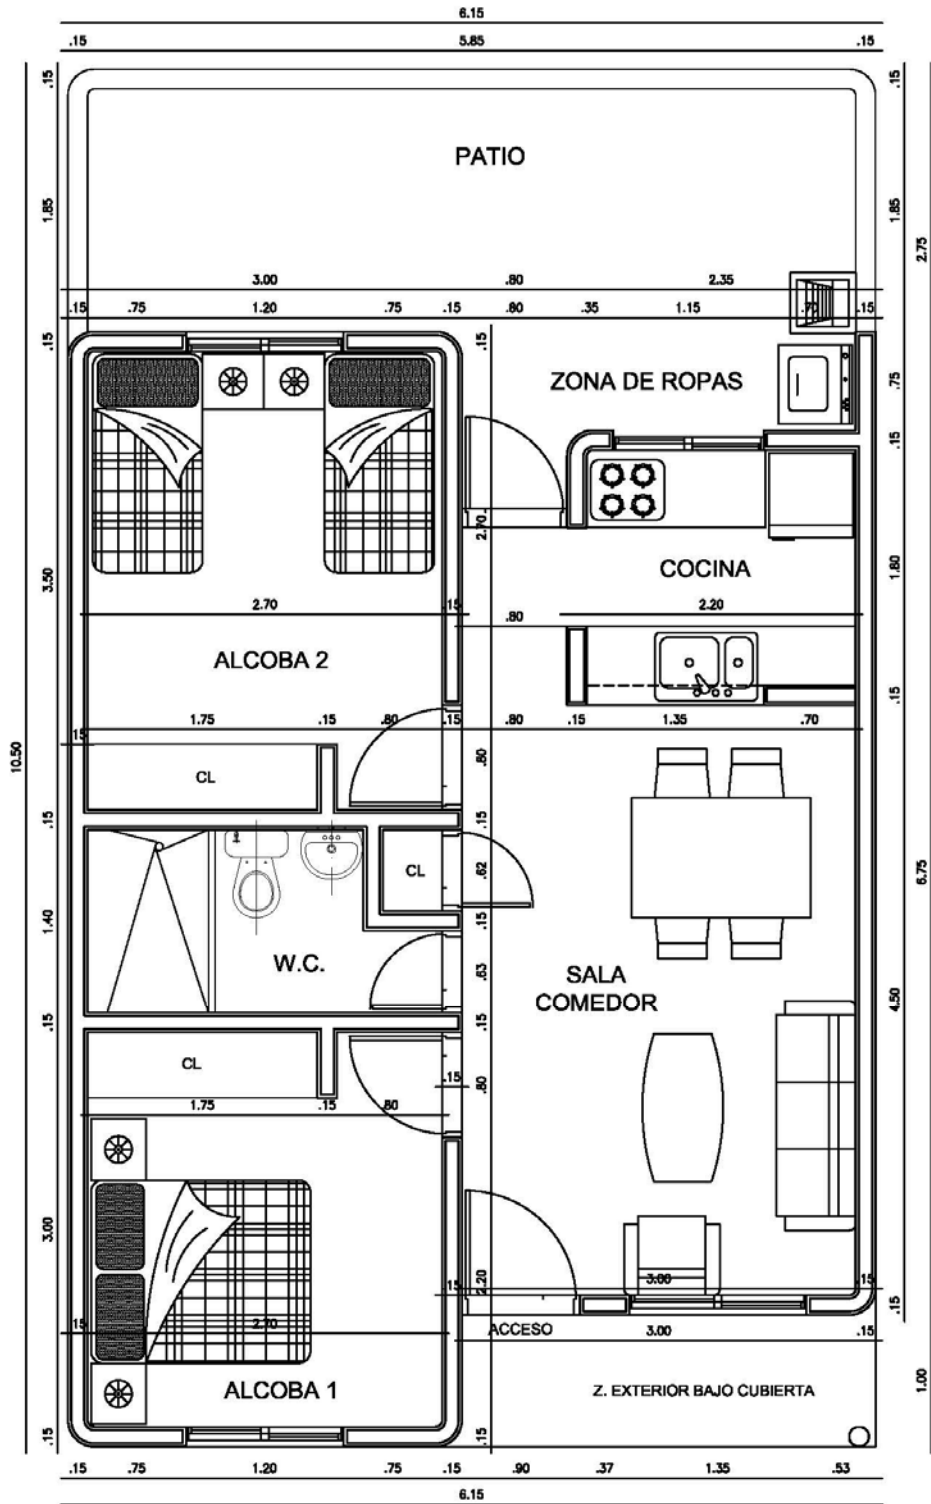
55. Planimetría arquitectónica para modelo de estudio
